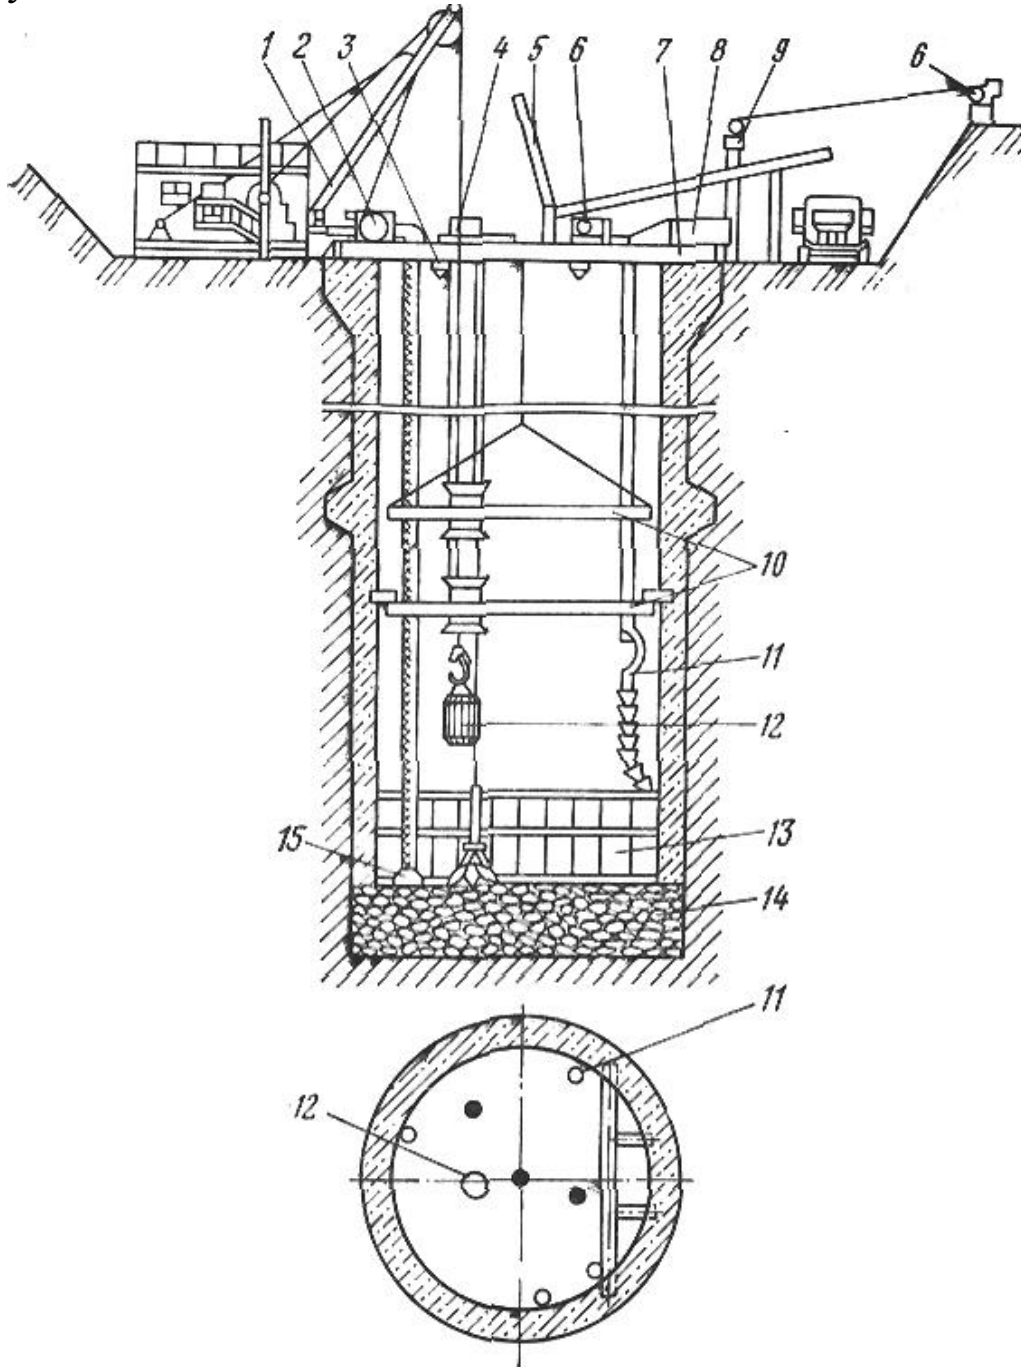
Схема проходки ствола на глубину 130 м: 1 – передвижная подъемная установка; 2 – проходческая лебедка ПЛП-1,5; 3 – светильник; 4 – пневматическая лебедка ЛППГ; 5 – разгрузочная лядя; 6 – лебедка для подвески трубопровода для подачи бетона; 7 – перекрытие ствола; 8 – бункер для подачи бетона; 9 – ферма шкива для опрокидывания бункера; 10 – подвесной полук; 11 – трубопровод для подачи бетона; 12 – проходческая бадья БП-1; 13 – щитовая опалубка; 14 – порода для пневмопогрузчика КС-3; 15 – забойный насос Н-1м
